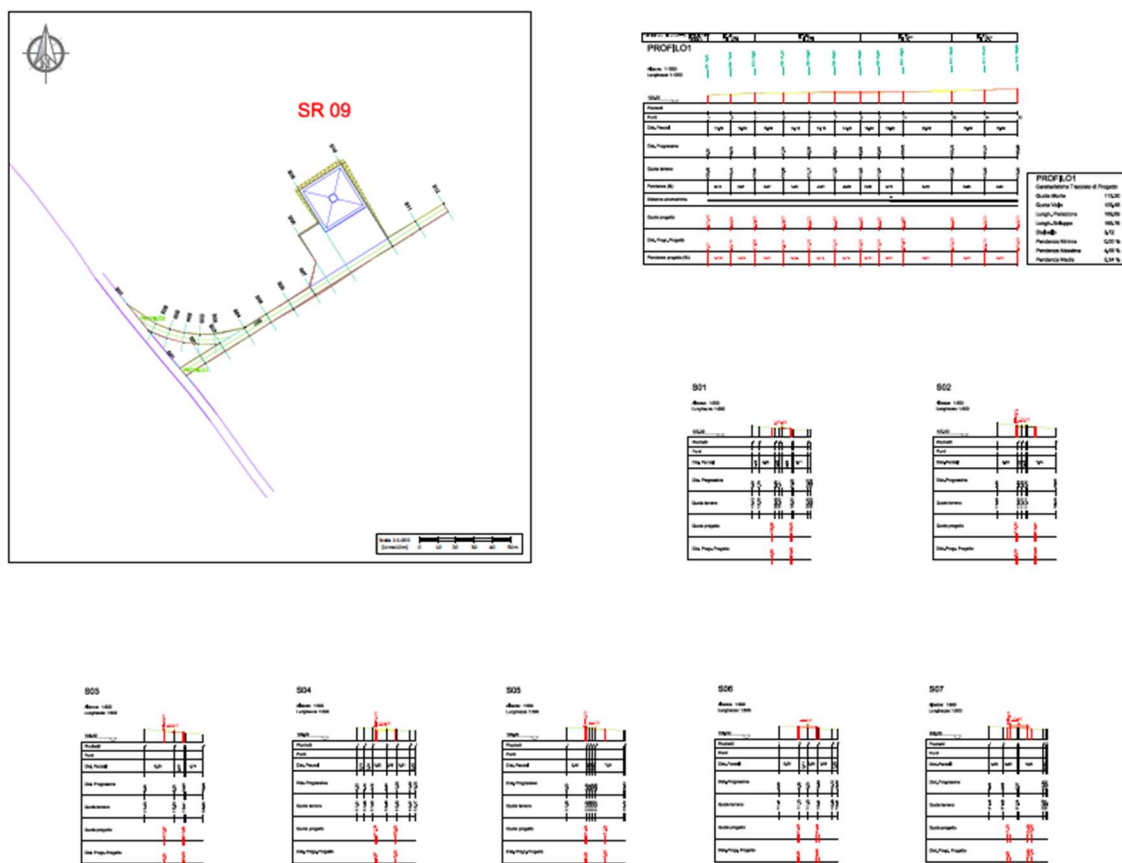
Estratto dell'elaborato grafico Sezioni stradali e profili con individuazione di aree di scavo e riporto.
